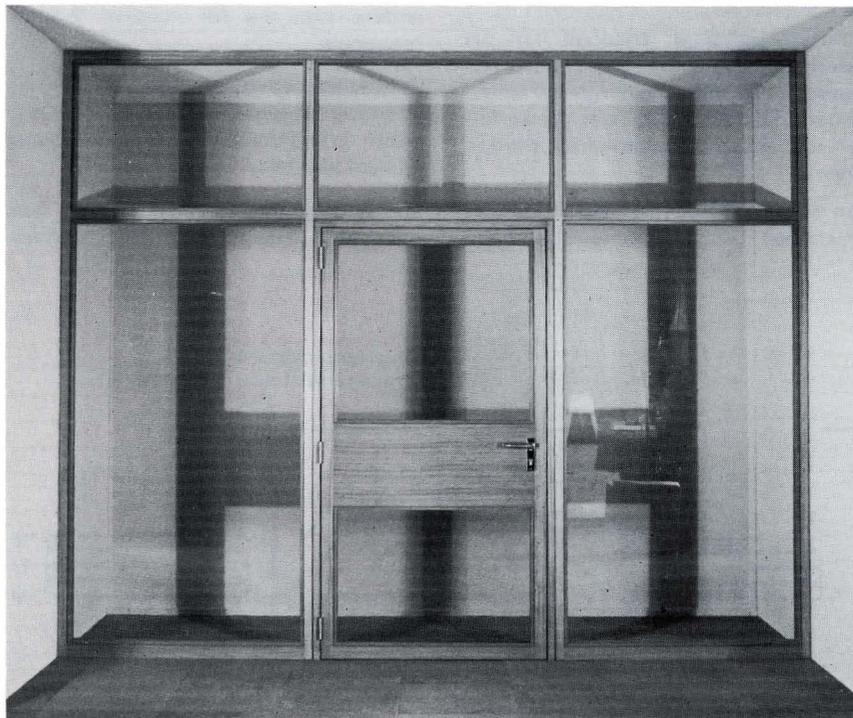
Ansicht einer einflügeligen, verglasten, feuerhemmenden Holztür, eingebaut in eine verglaste feuerhemmende Trennwand (Form Brandschutztür Typ 25 SG gemäß Zulassung Nr. Z-6.16-1073 in Verbindung mit Glastrennwand gemäß Zulassung Nr. Z-19.14-33)
